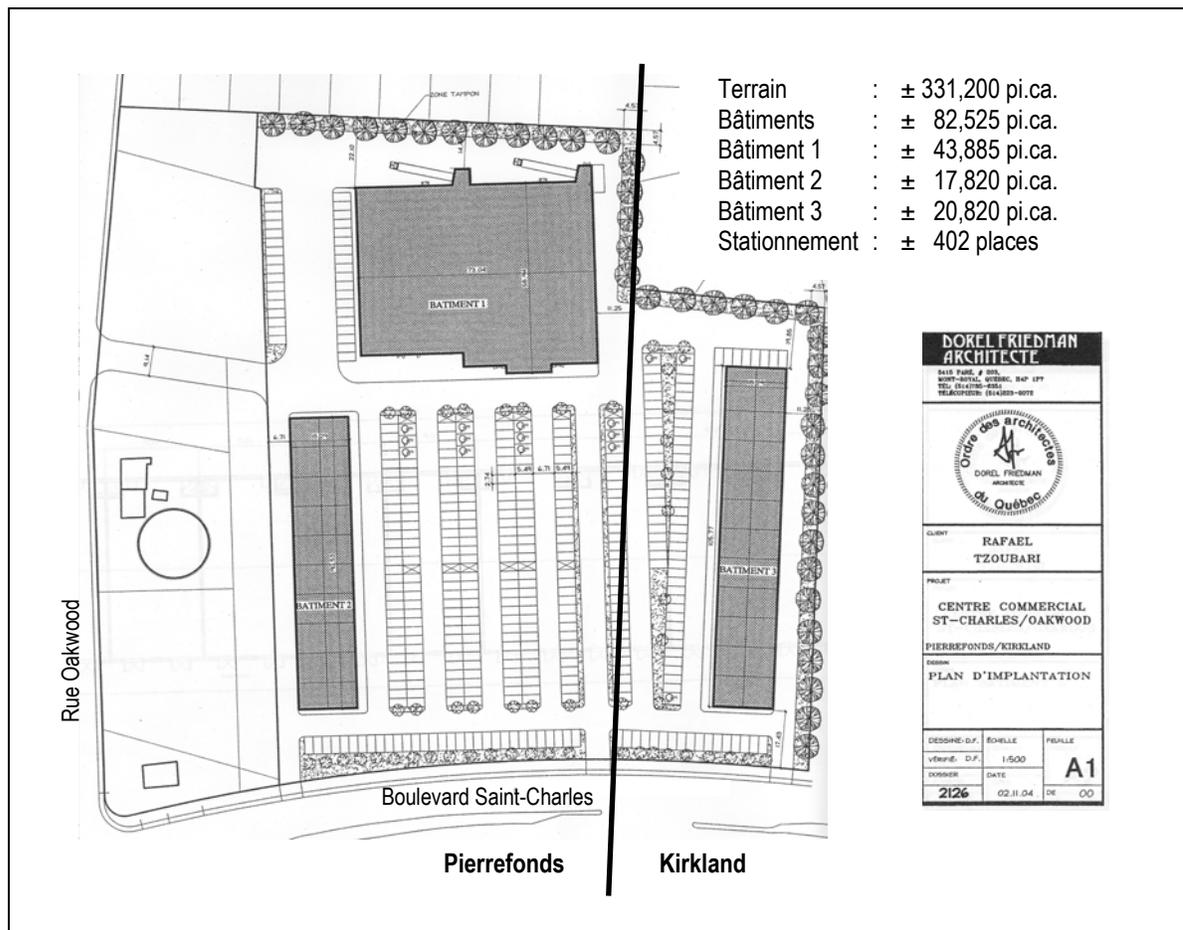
Plan d'implantation du centre commercial « Galerie Oakwood » (extrait du plan préparé par Dorel Friedman, architecte).
